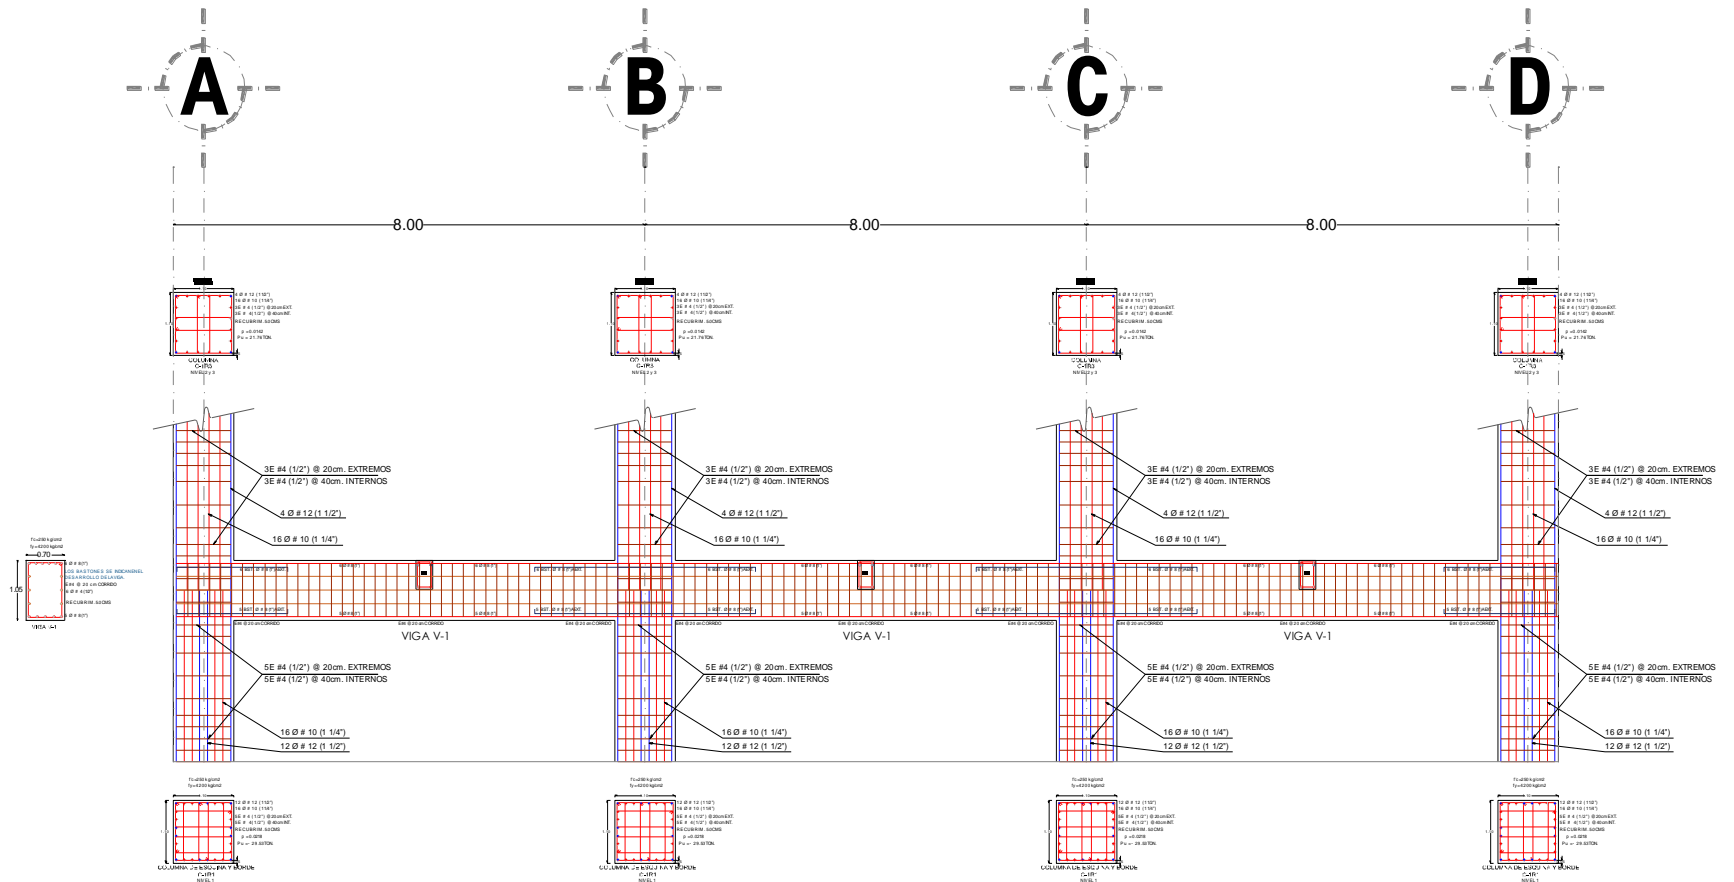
Alzado de armado de columnas y vigas de edificio de 9 niveles con base a la hipótesis de las NTCC-17.
